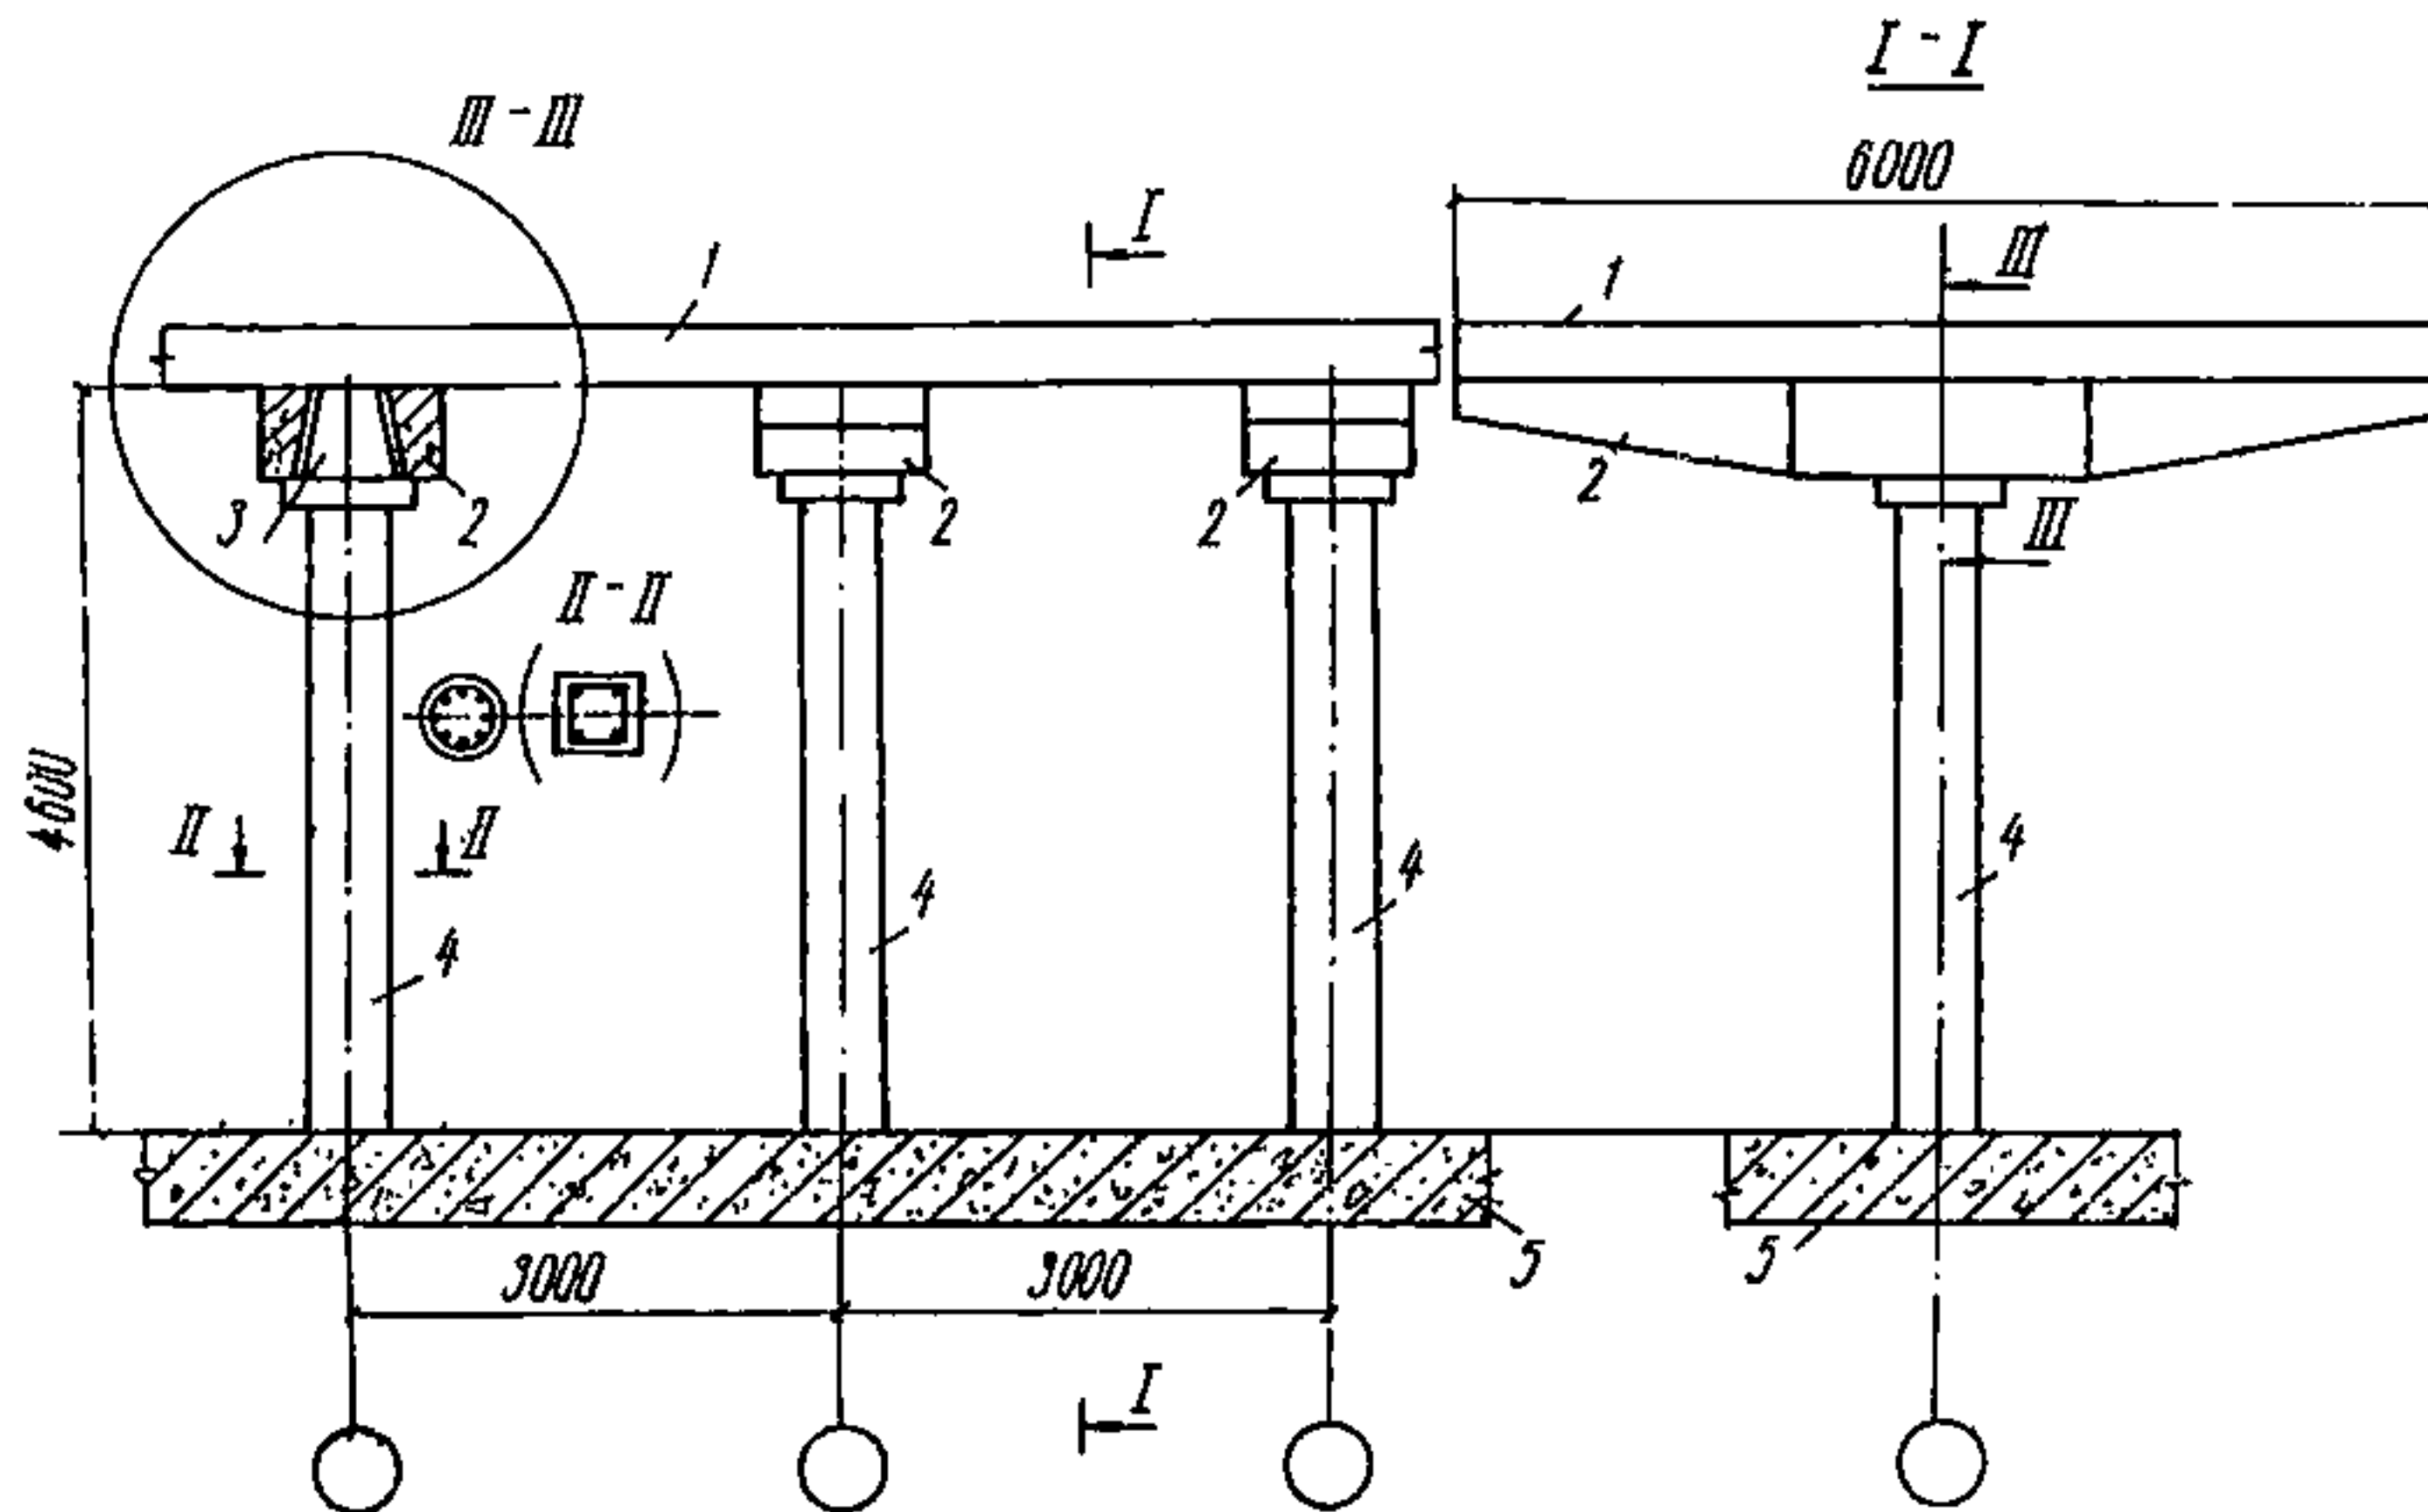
Схема рамного фундамента с одним рядом колонн по оси фундамента
